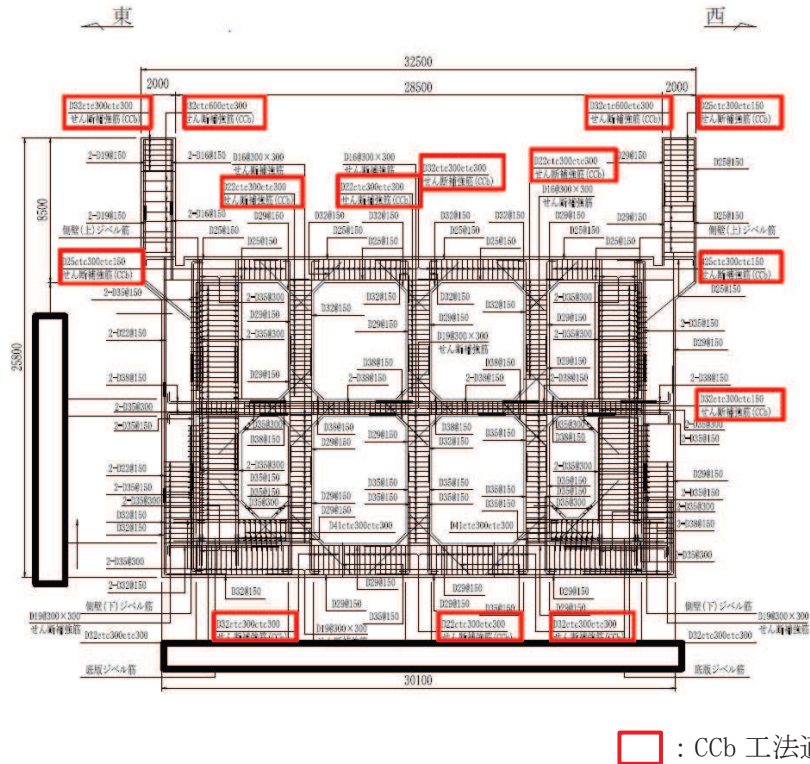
海水ポンプ室概略配筋図 (A-A 断面, 東西 (スクリーンエリア))
